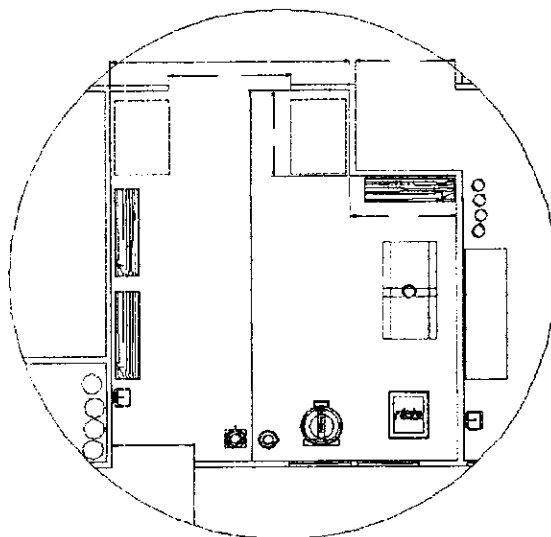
PLANO ÁREA PRODUCCIÓN BASE PARA CREMA
